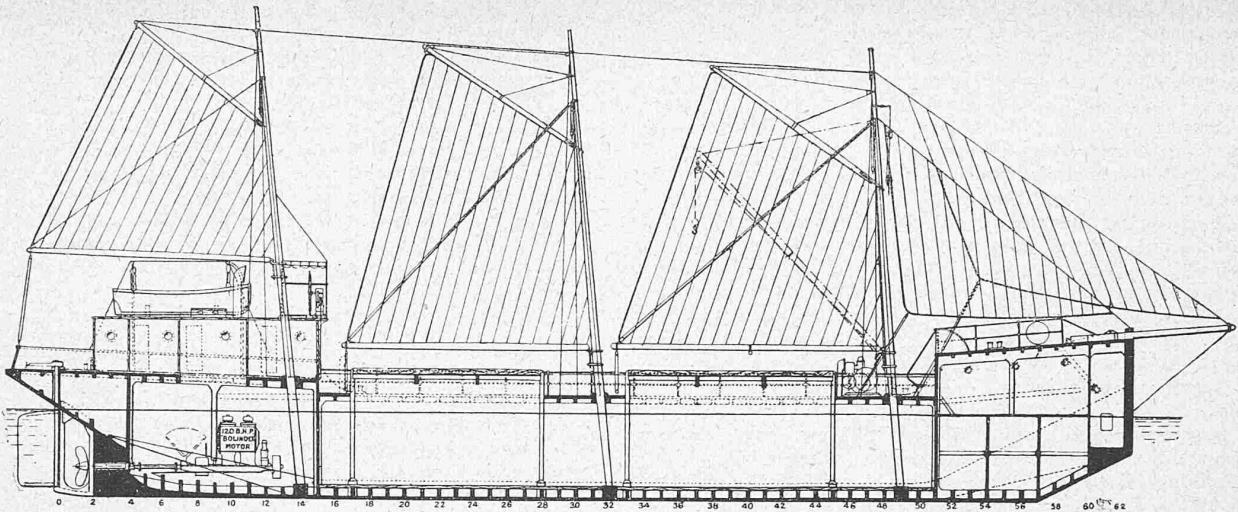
Küstenfahrer aus Eisenbeton. — Tragfähigkeit 270 t, Gewicht der Schale 260 t. — Längsschnitt 1:250 (nach „Engineering“).
